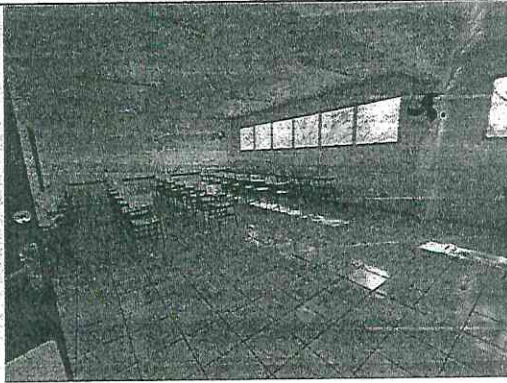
Trinca no encontro da laje / parede. Piso em concreto com deslocamento.
